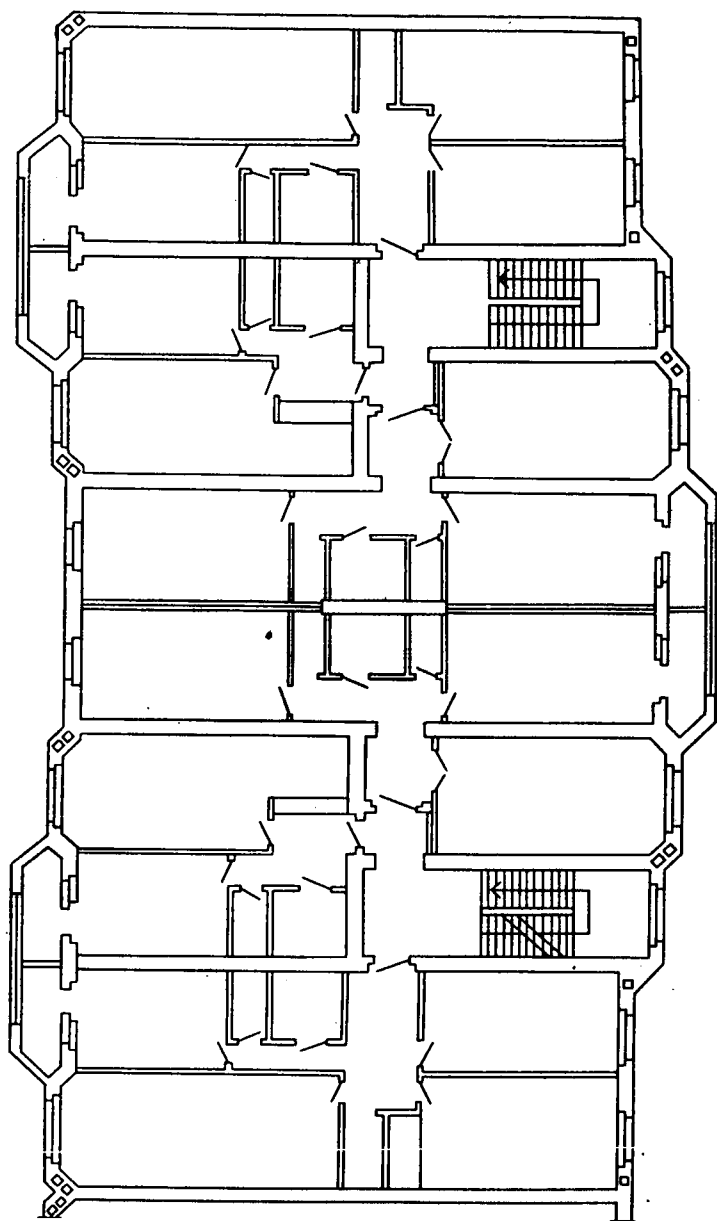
План кирпичного дома с вентиляционными каналами в наружных стенах
